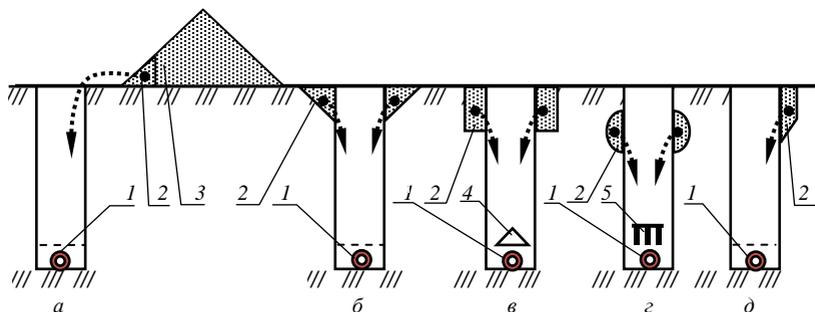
Схемы присыпания дрен: а – с возвратом грунта из кавальера; б – с треугольным обрушением кромок траншеи; в – с прямоугольным обрушением кромок траншеи; г – с подрезанием стенок траншеи; д – с обрушением одной кромки траншеи: 1 – дренажная труба; 2 – грунт присыпки; 3 – кавальер; 4 – пирамидка; 5 – гребенка
